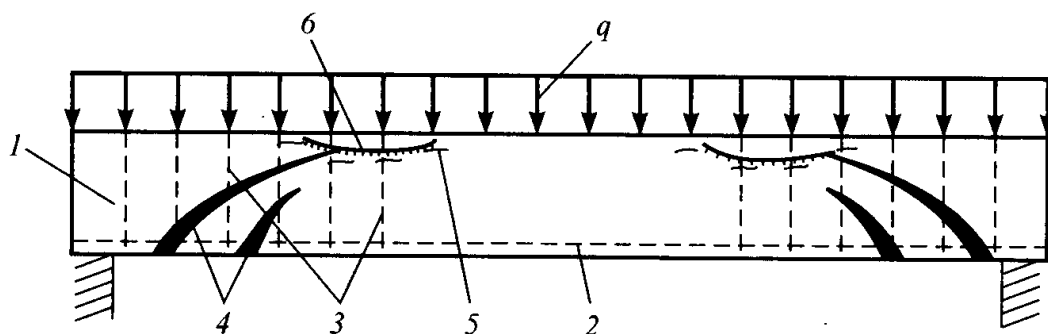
Оценка по раздроблению бетона сжатой зоны над наклонной трещиной:
